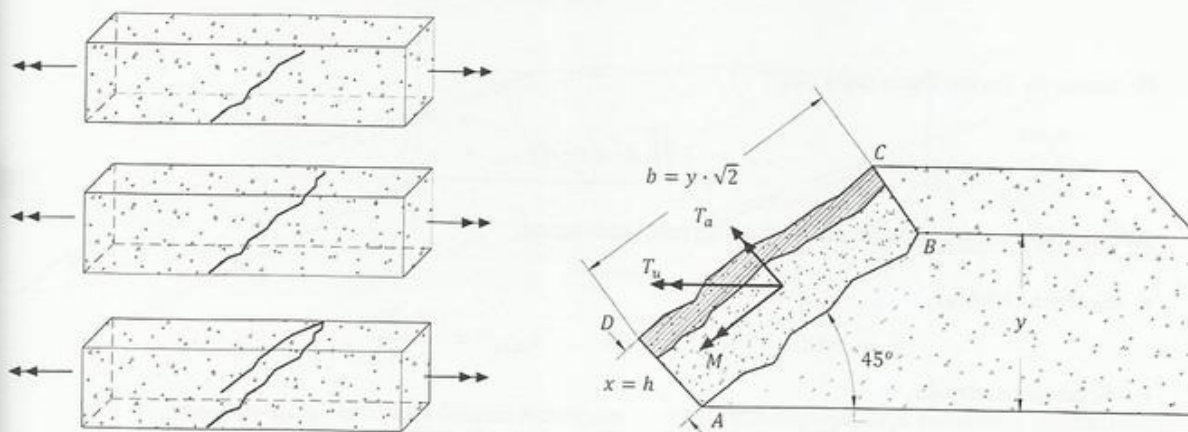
Falla de una viga de concreto sometida a torsión.
